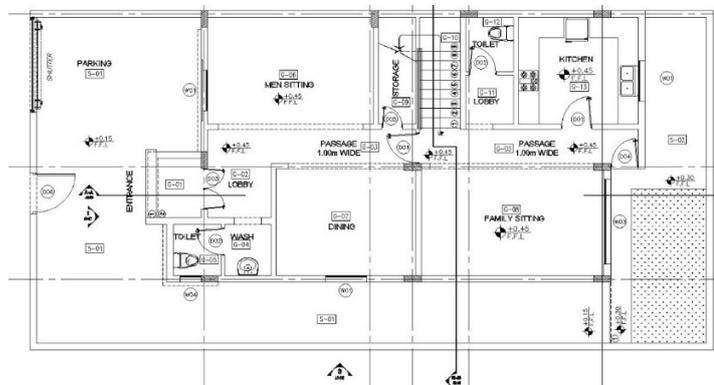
Planta baja arquitectónica. Proyecto Printland.
